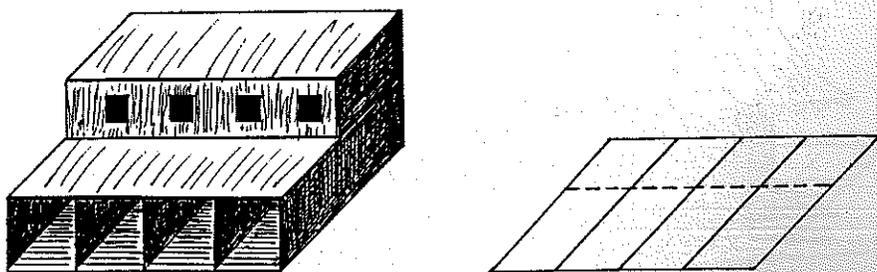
Eingeschossiger Suqbau mit aufgesetztem Halbgeschoß
